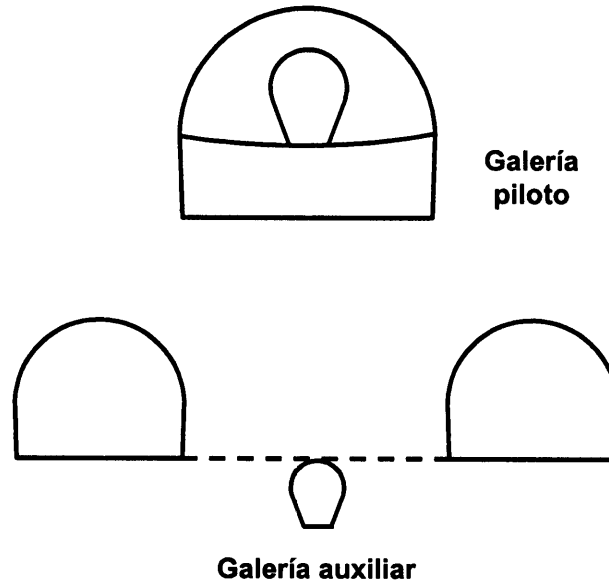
Galería auxiliar y galería piloto según CETU (1975).
